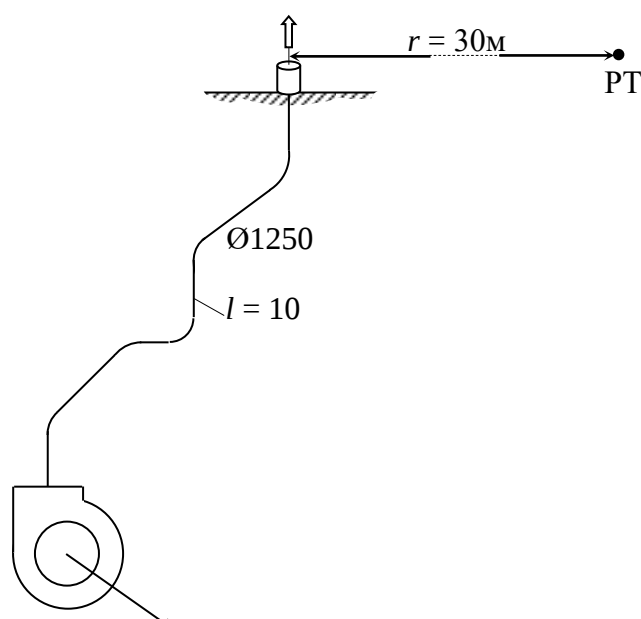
Схема вытяжной вентиляционной сети – сторона нагнетания
